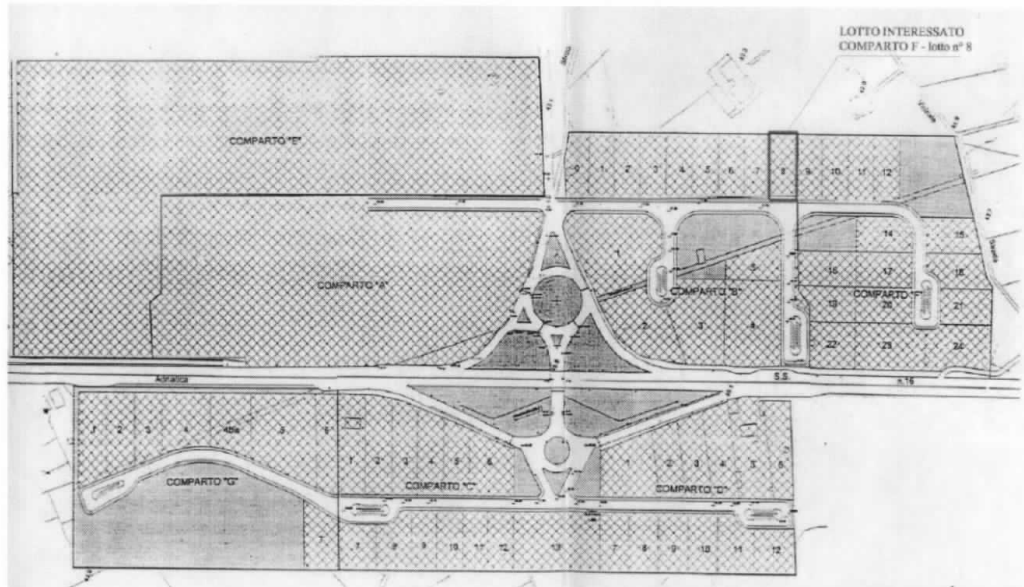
/5 – Zona P.I.P Stralcio comparto F – planimetria di insieme e zoom del comparto F – lotto n. 8
